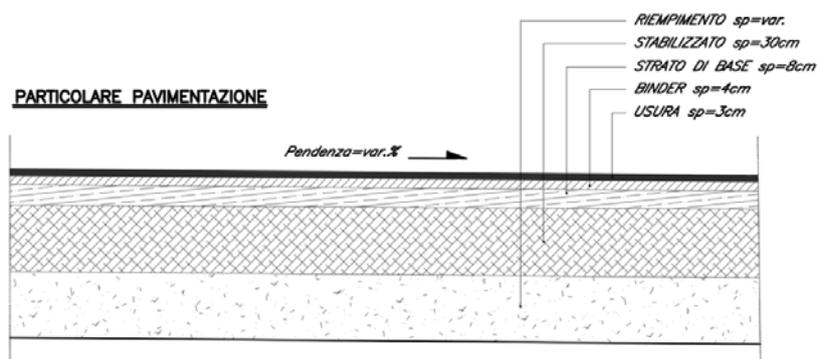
Pacchetto di pavimentazione Sublotto
